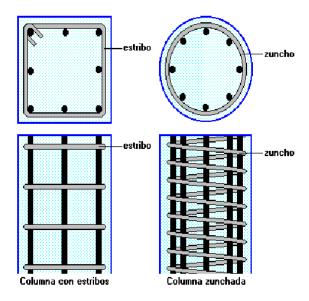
Columnas de hormigón armado con estribos y zunchadas.
